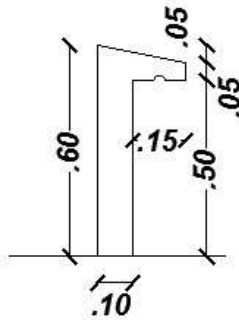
Acrotère type 2 (Terrasse inaccessible)
